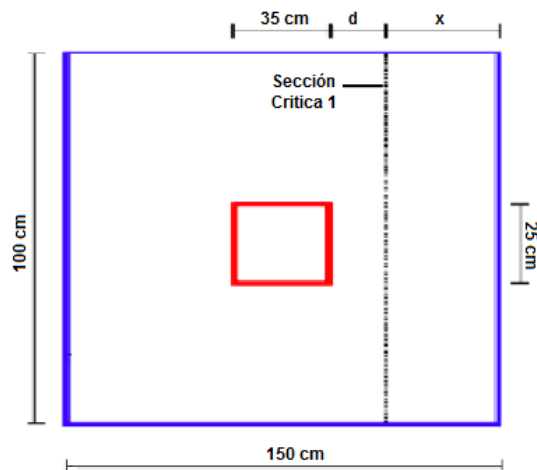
Zapata Esquinera - Cortante Tipo Viga
